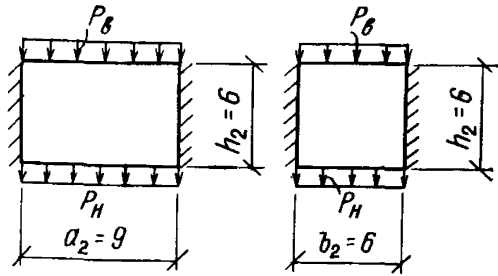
Расчетная схема вертикальных стенок при расчете на общий изгиб
